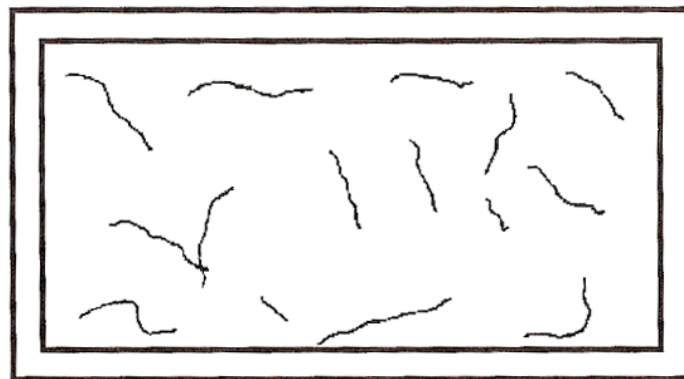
Fissuras de retração por secagem em lajes (Souza, 1999).
